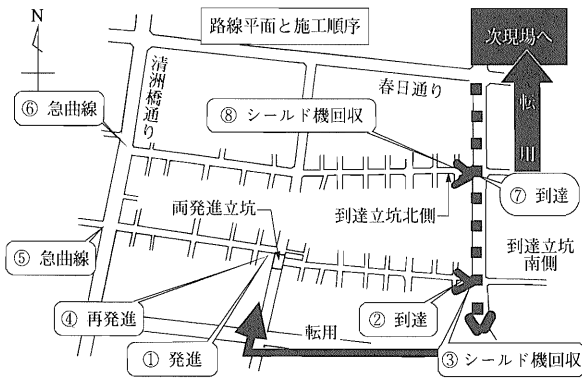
台東区三筋二丁目、鳥越二丁目付近再構築工事平面図
